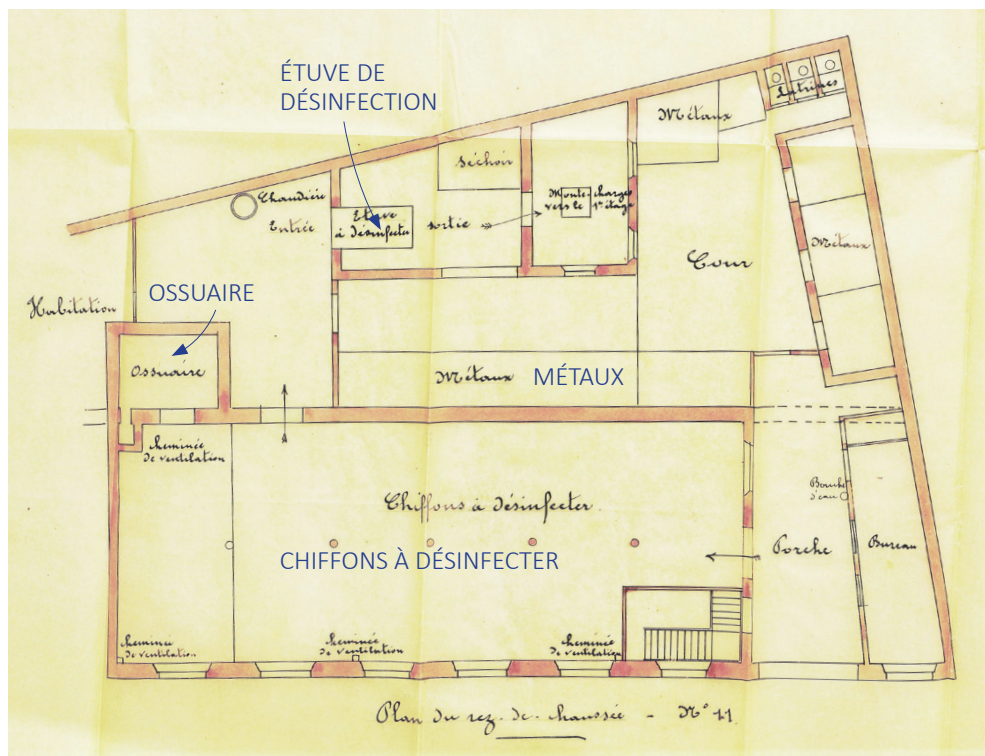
Plan du rez-de-chaussée du n° 11 de l'entreprise Lhoest
